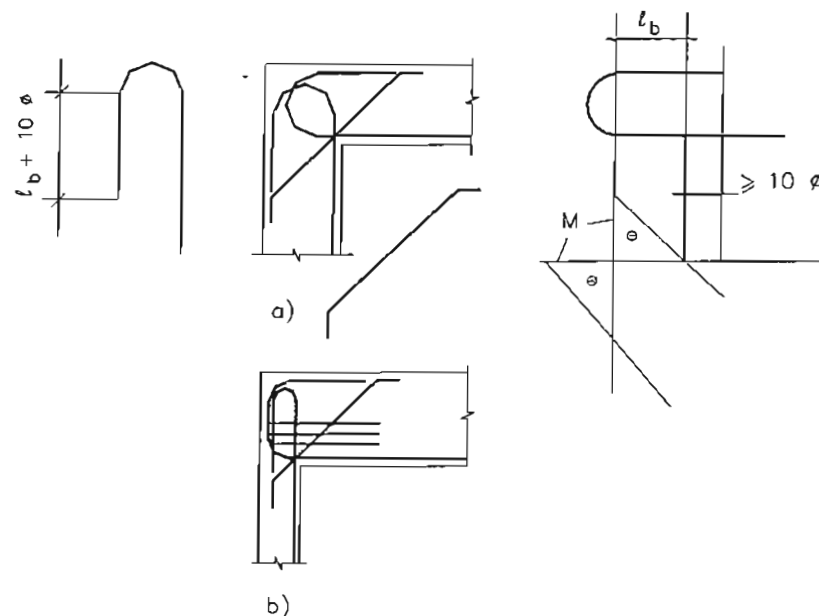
Detalhe de armadura de ligação viga de cobertura - pilar extremo
